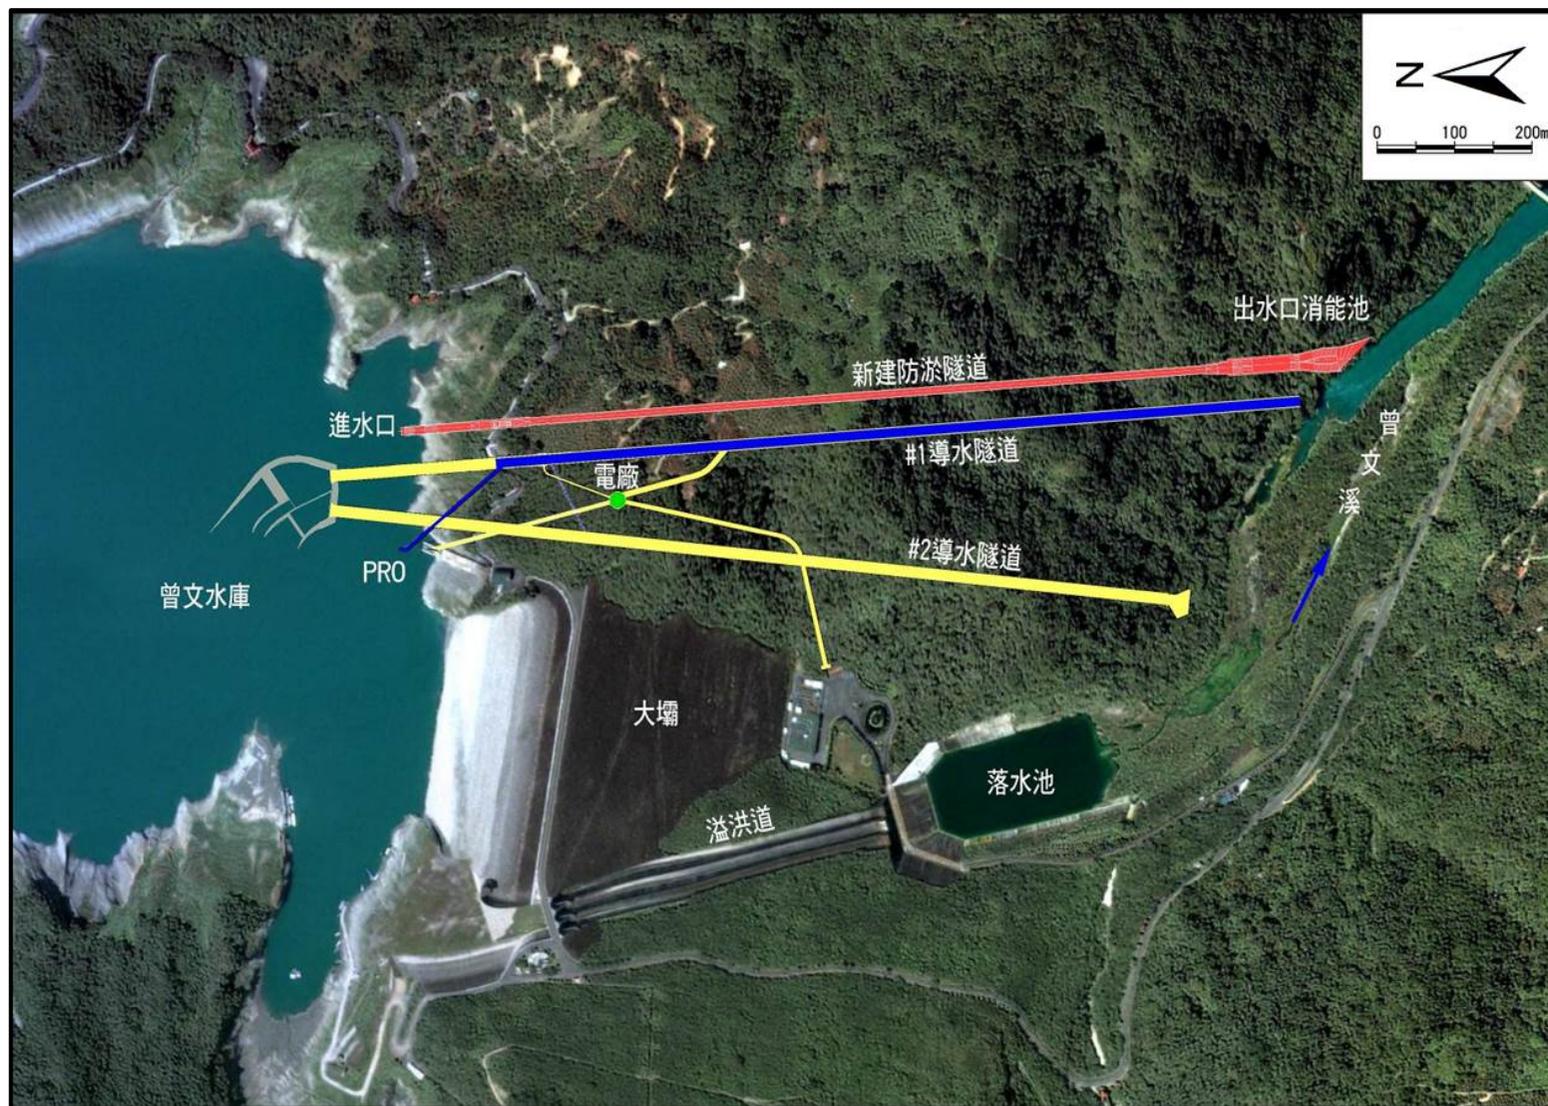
曾文水庫 PRO 整體平面布置圖
